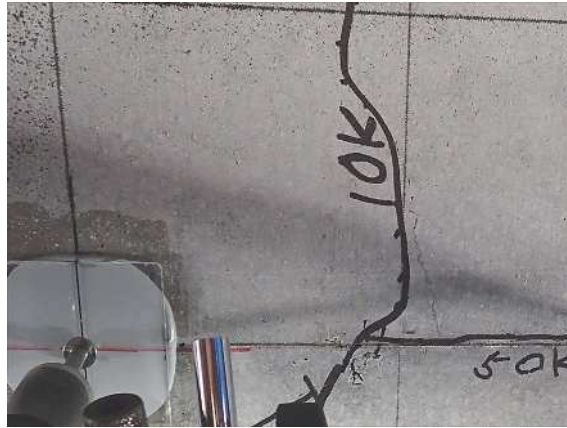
支間中央部下面のひび割れ（軽量 RC）
